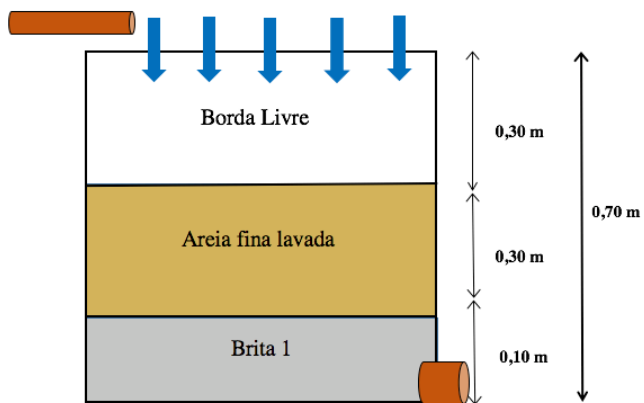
Perfil longitudinal do SAC 2 plantado com cana do brejo.
